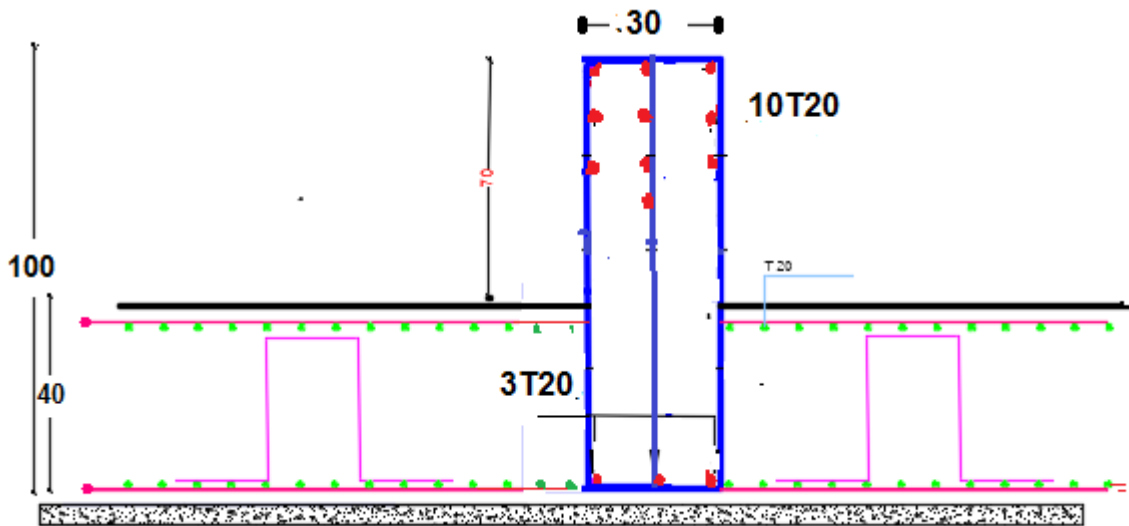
dessin de ferrailage d'une poutre principale en appuis.
